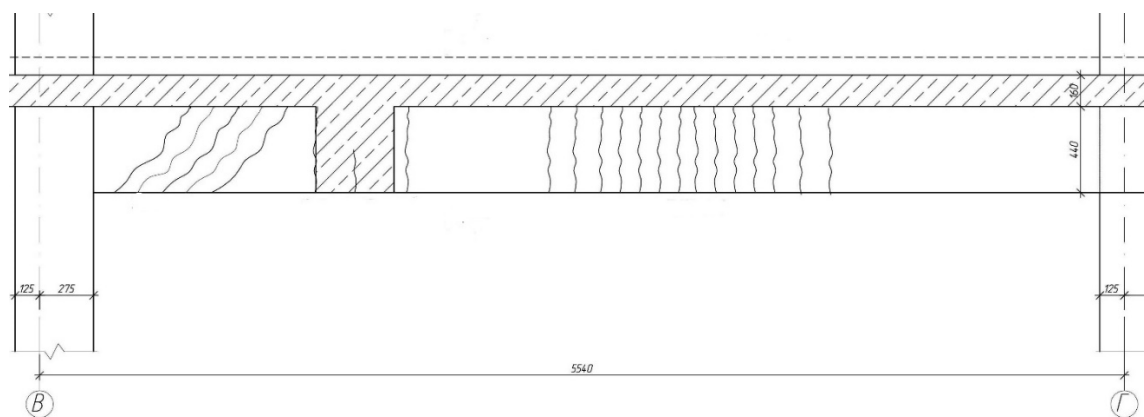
Схема розташування тріщин на поверхні поздовжньої балки перекриття над підвалом
